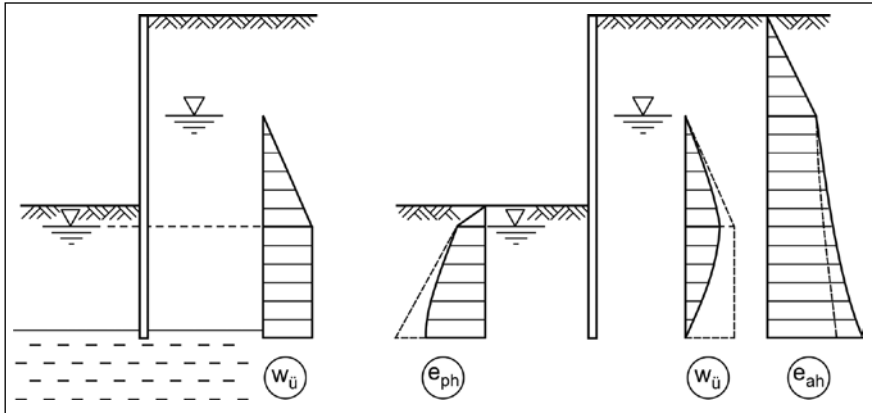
■ Wirklichkeitsnahe Lastfiguren gemäß EAB [10] für Spund- und Ortbetonwände
